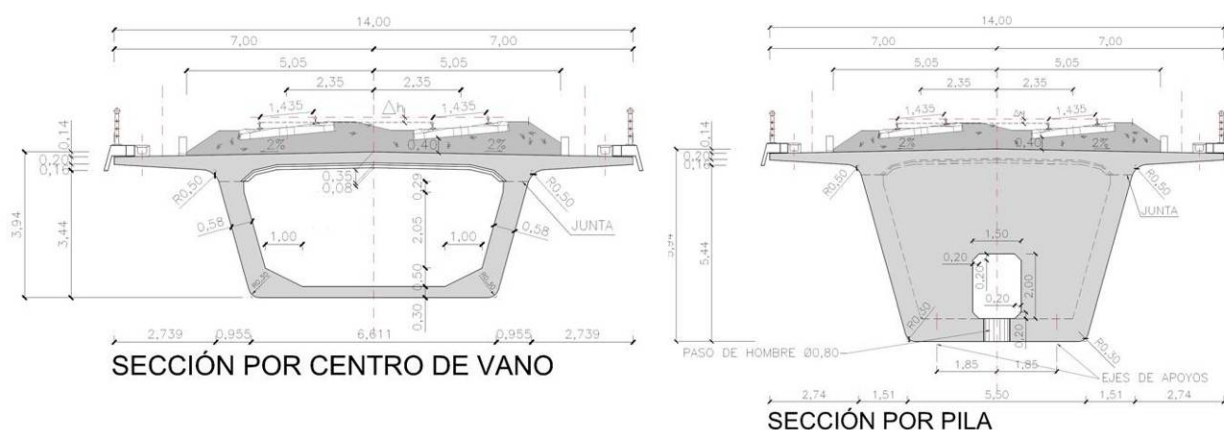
Secciones transversales tipo de centro de vano (izquierda) y por zona sobre pilas (derecha)
